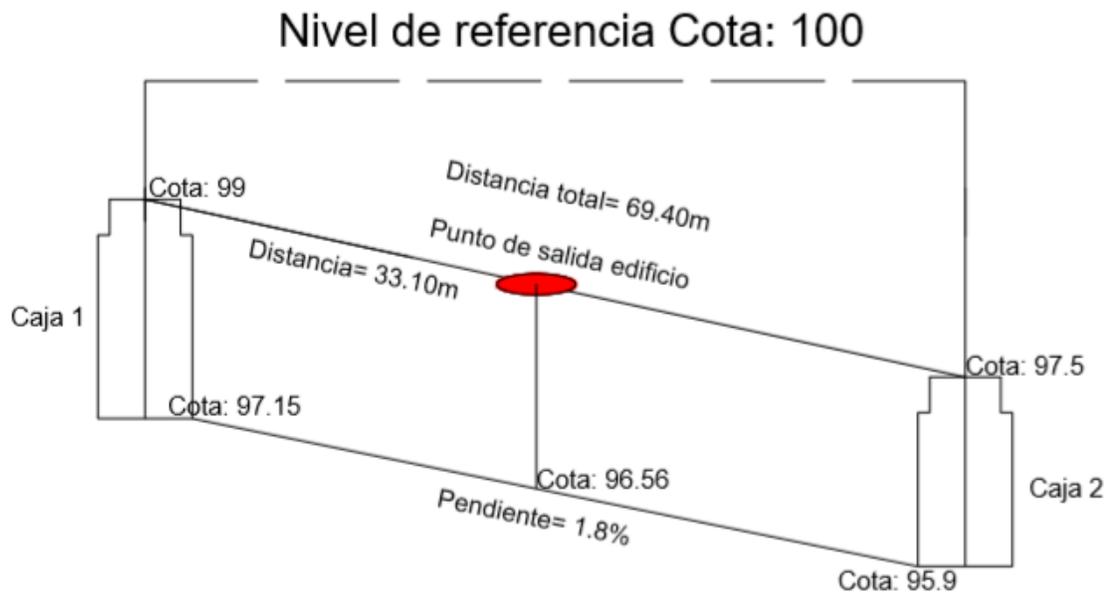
Desnivel alcantarillado calle 16AN. Escala vertical 1:10. Escala horizontal 1:100
